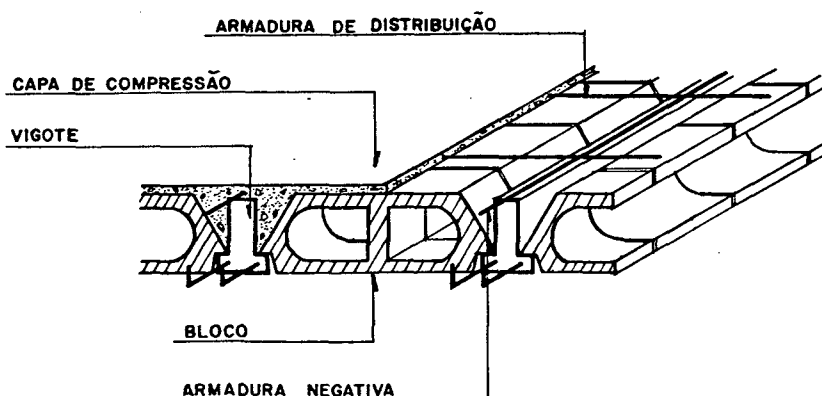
LAJE PRÉ-MOLDADA SEMI-RESISTENTE
